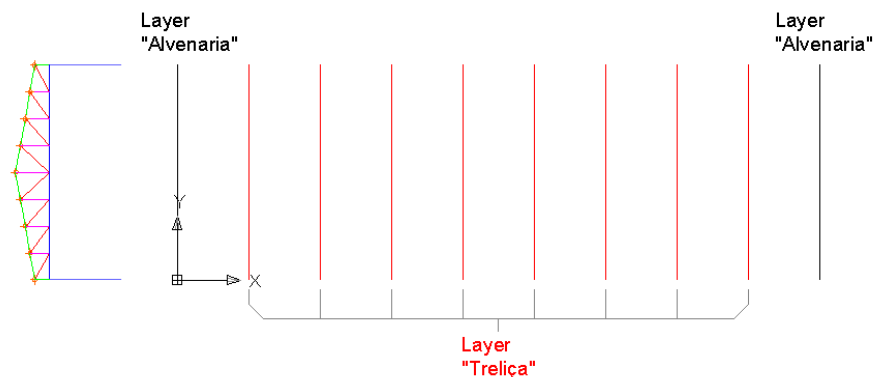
Representação das treliças na planta de contraventamentos da estrutura.
